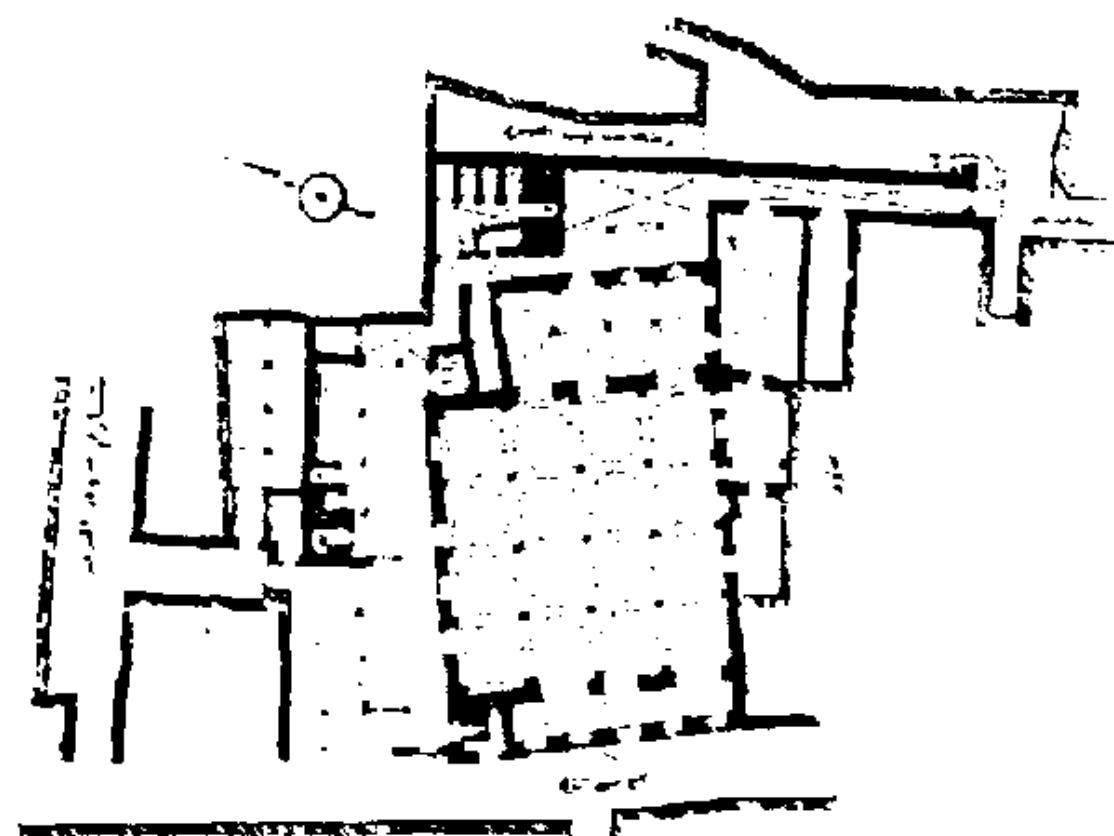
مسقط أفقى لجامع النخل عن الموسوعة (الجزء الأول).
